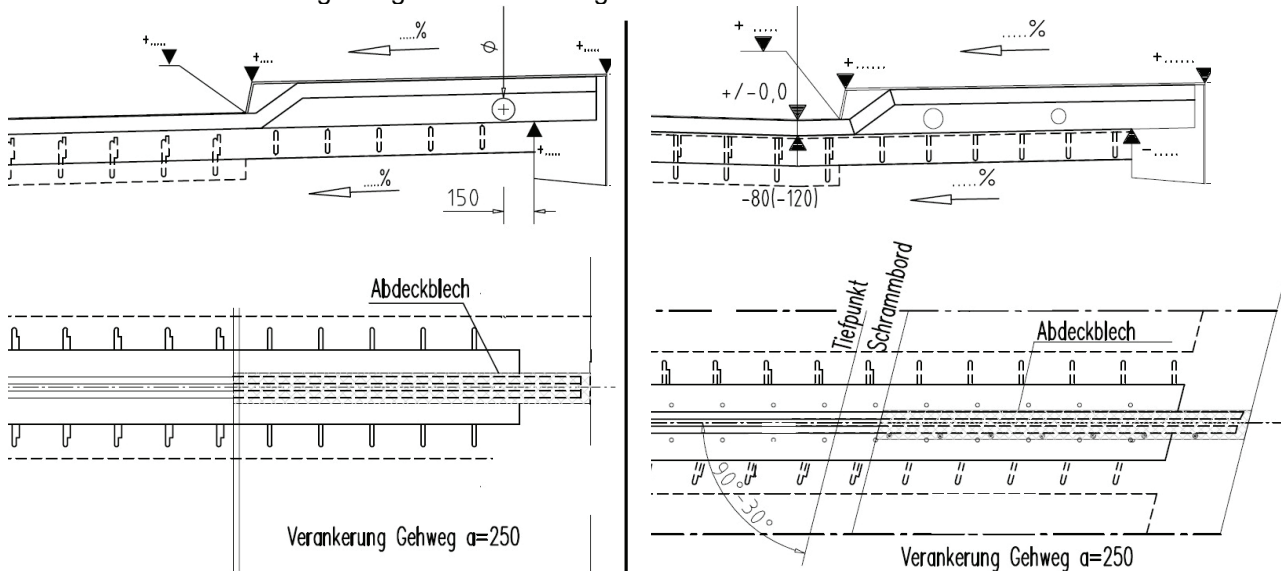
Längsschnitt und Grundriss Dehnfuge Typ 80-1 in rechtwinkliger / schiefwinkliger Ausführung
